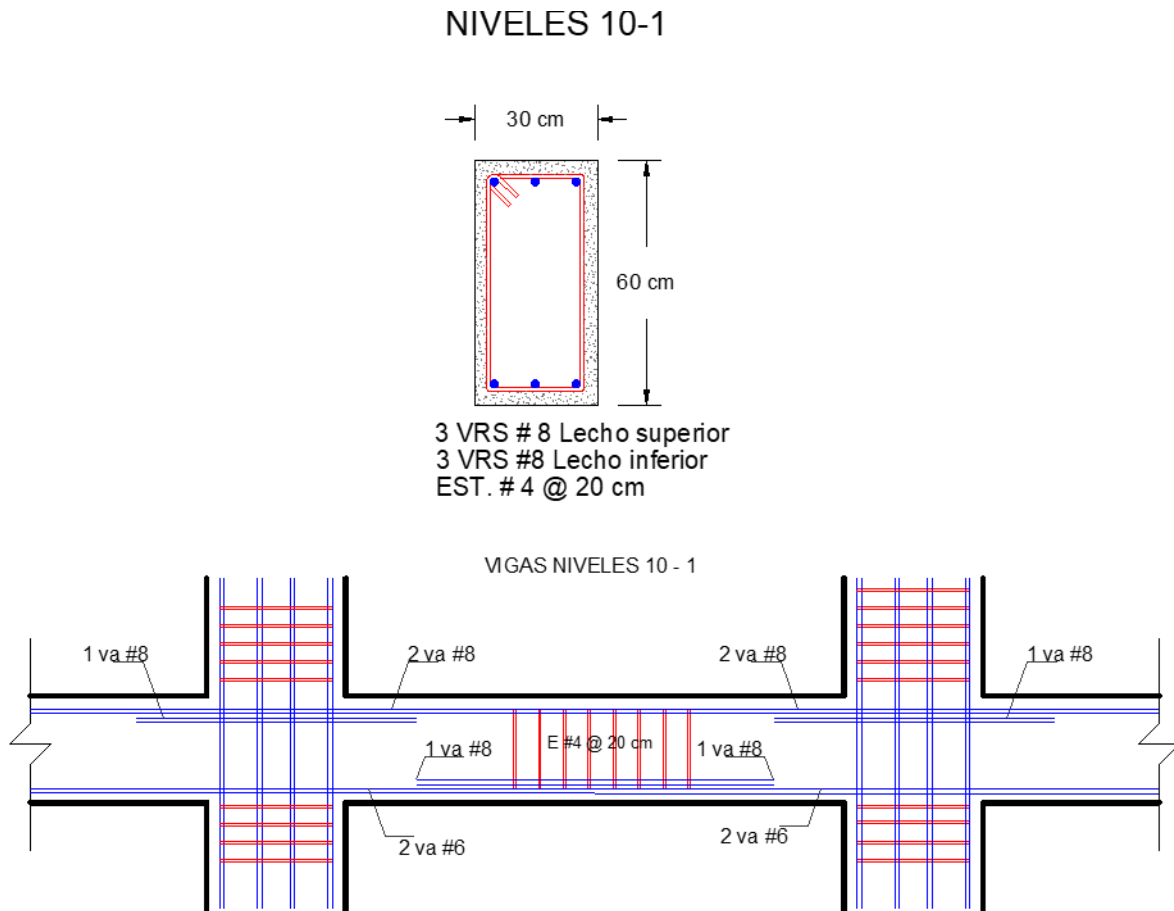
Detallado del refuerzo en vigas en el diseño por desplazamientos.
